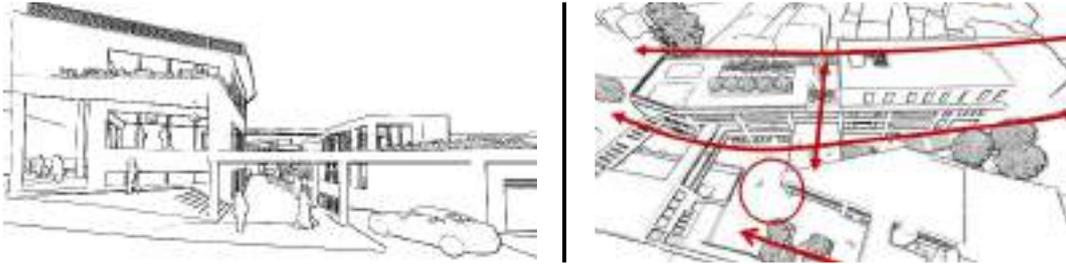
Acceso Calle del Embudo (izquierda), Recorridos planteados (derecha).
